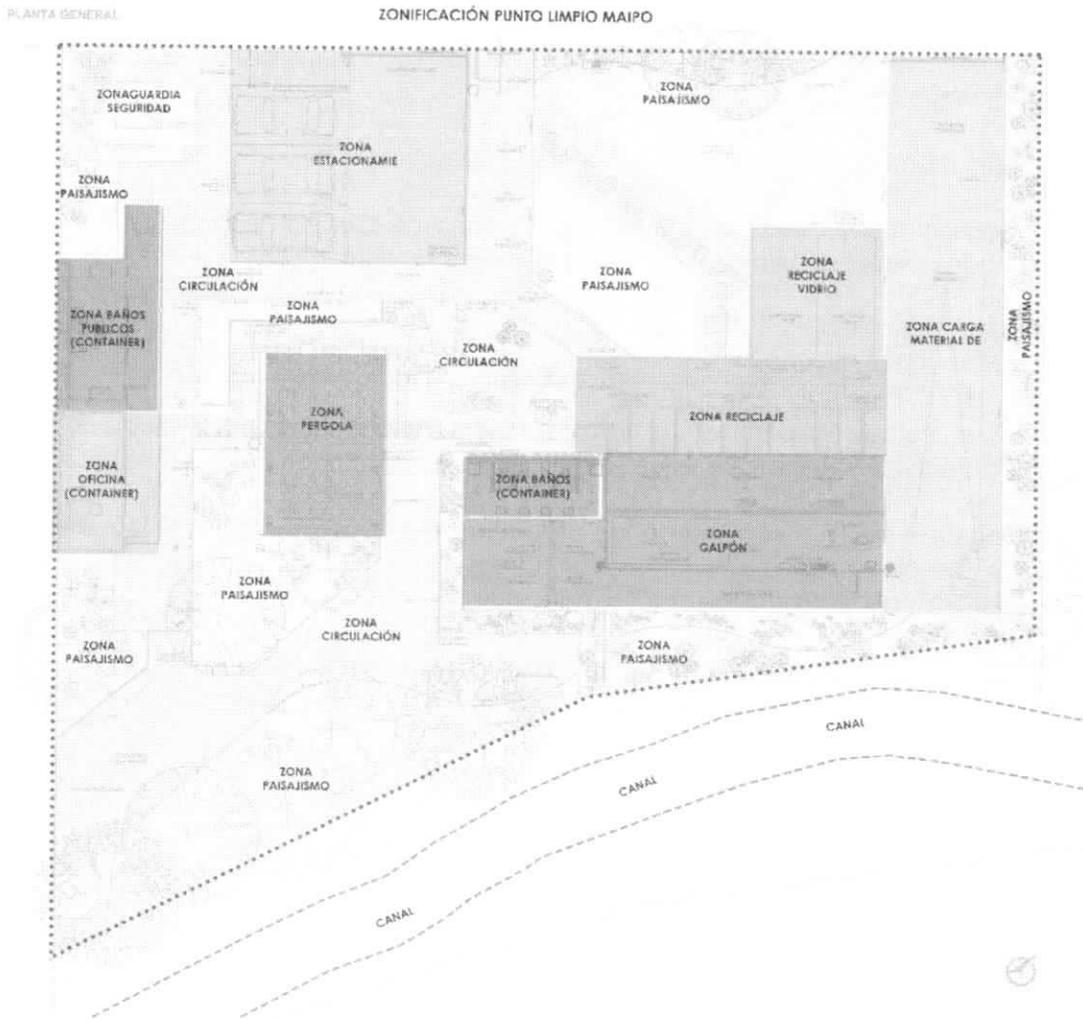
Imagen planta general proyecto con zonificación, elaboración SECPLA Buin.
